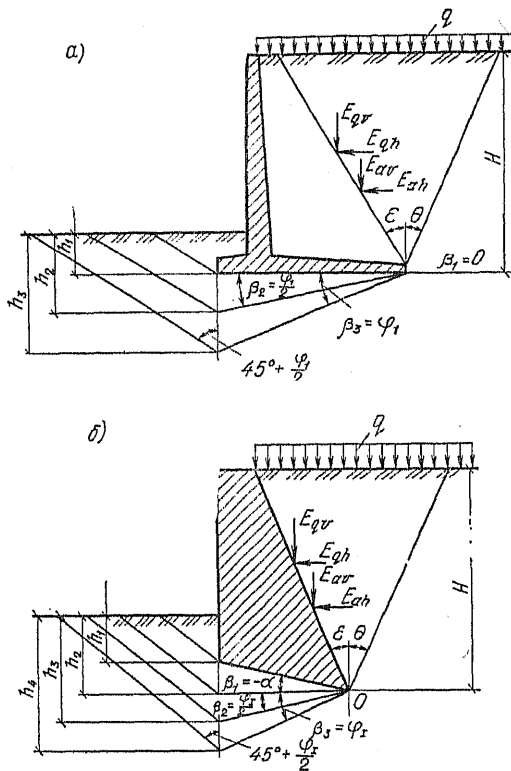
К расчету устойчивости подпорной стены а — с горизонтальной подошвой; б — с наклонной подошвой
